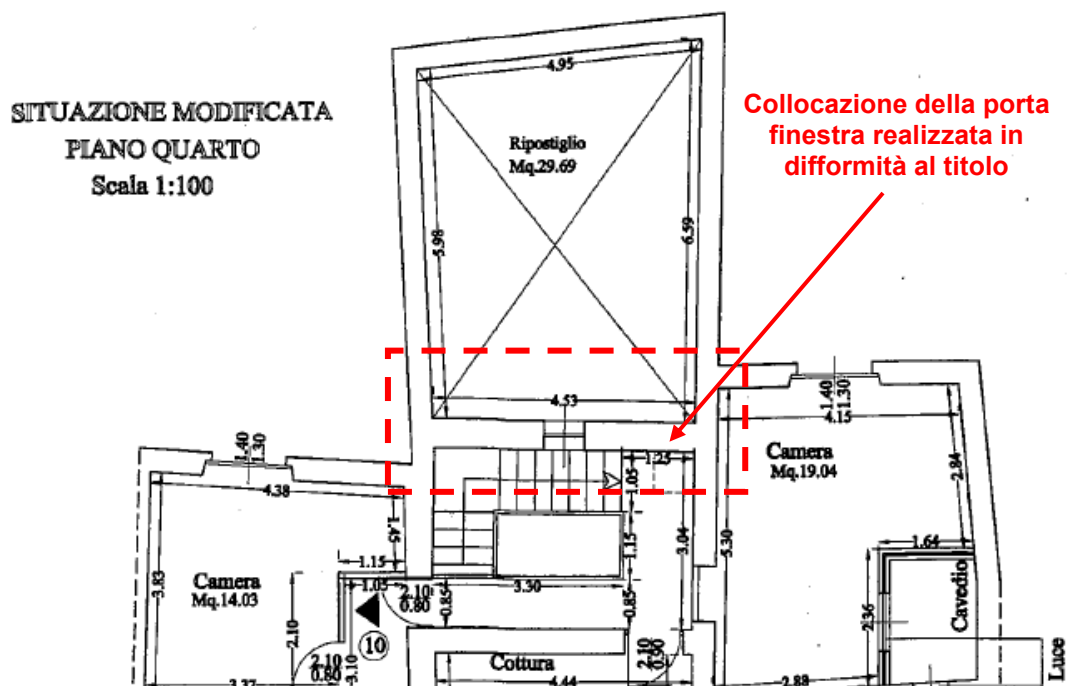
Stralcio del progetto approvato. A.E. 93/2005
